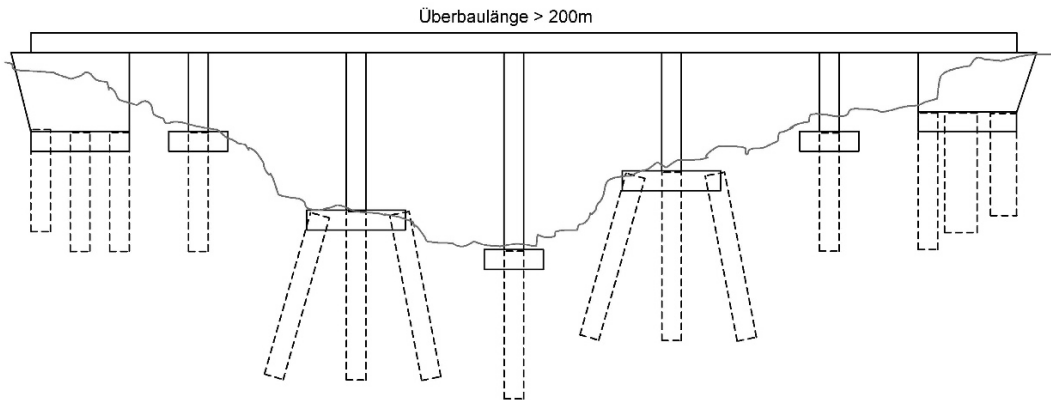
Prinzipdarstellung der Abfangung einer Brücke mit Bohrpfählen unter den Widerlagern und Stützen
